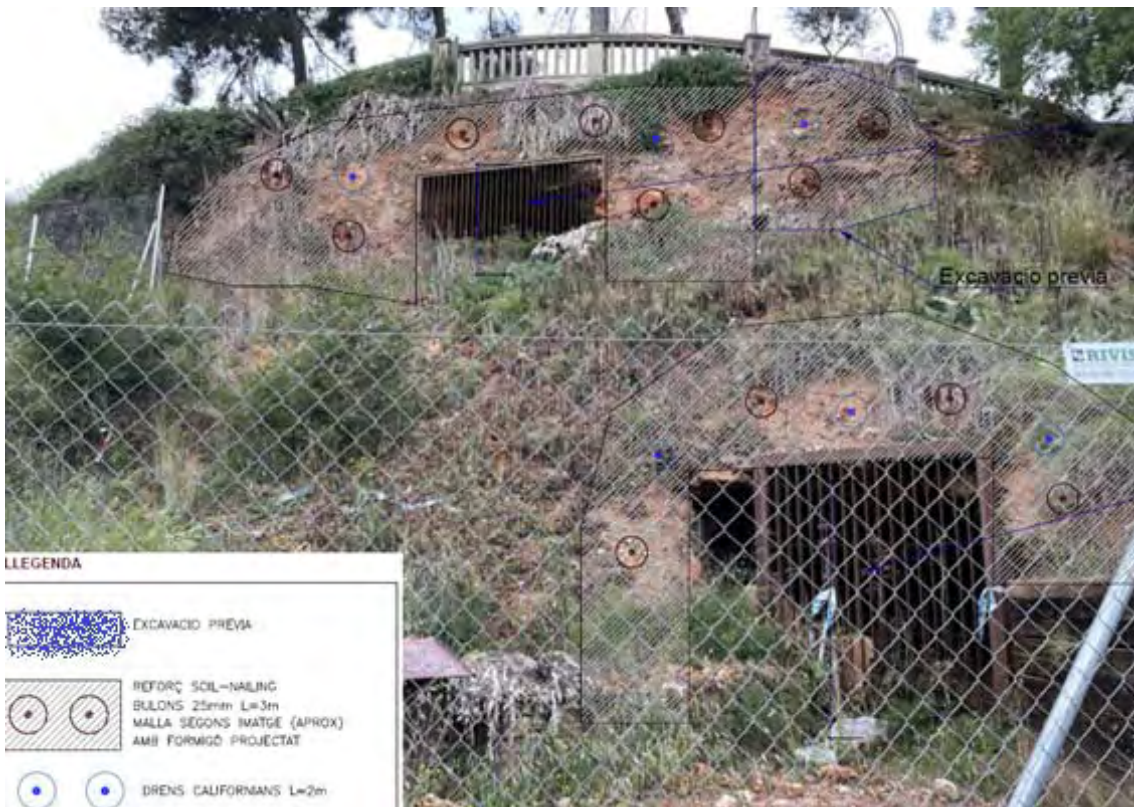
Solució 1: Soil-Nailing, zona perfil 2.
